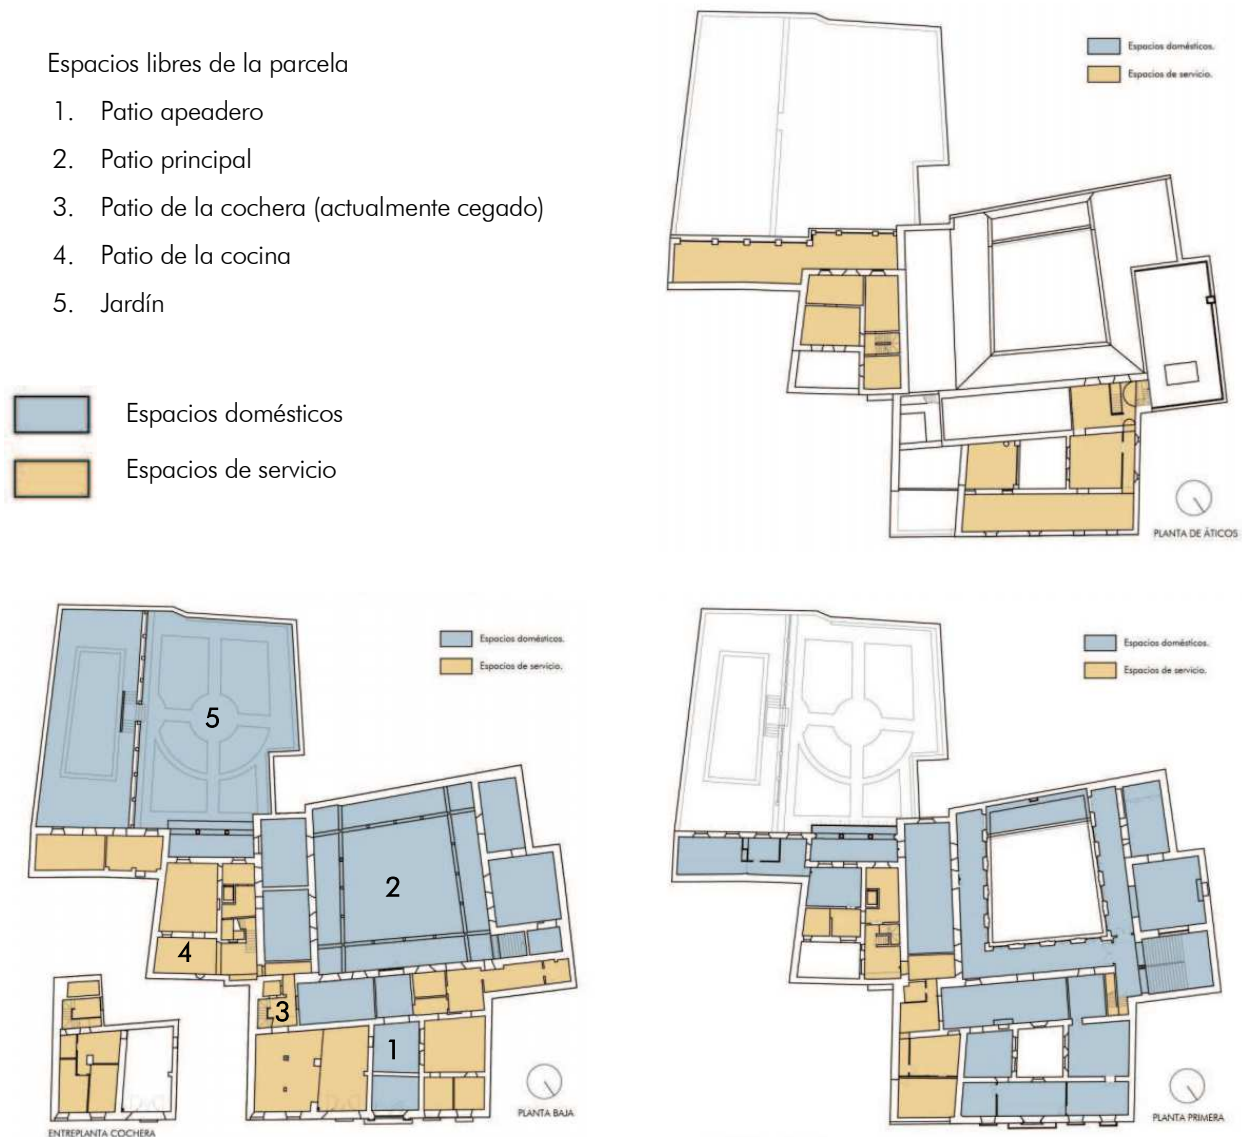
Distribución de usos actuales y espacios libres de la parcela. De izquierda a derecha y de abajo a arriba; planta baja, planta primera y planta de cámaras
